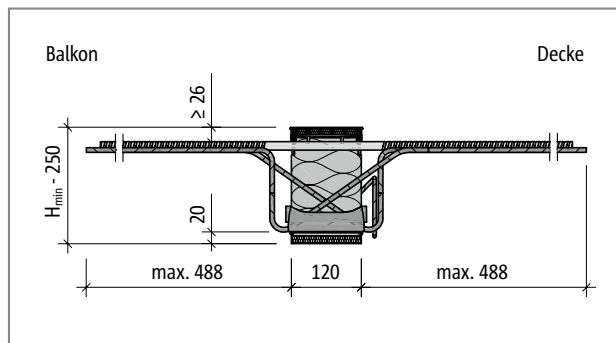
Schöck Isokorb® CXT Typ K-M7-VV1: Produktschnitt
